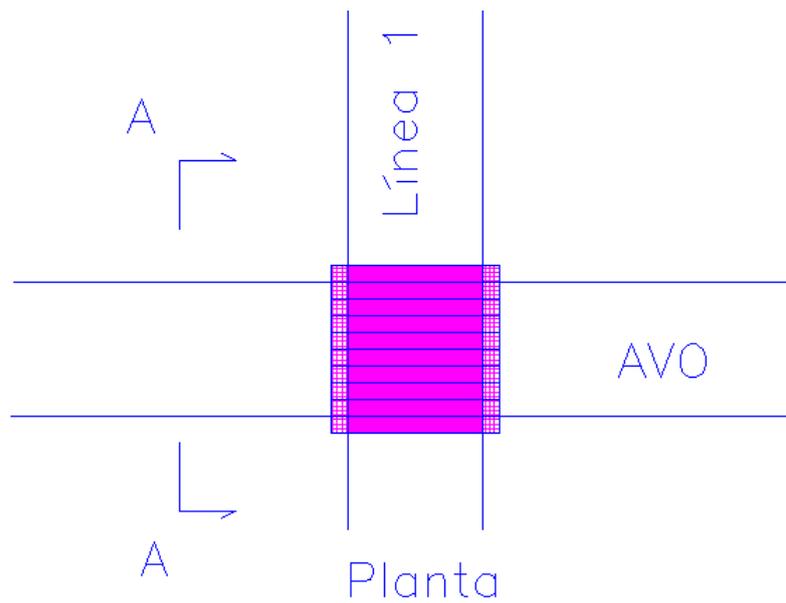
Planta de socialzado Línea 1 del Metro de Santiago
